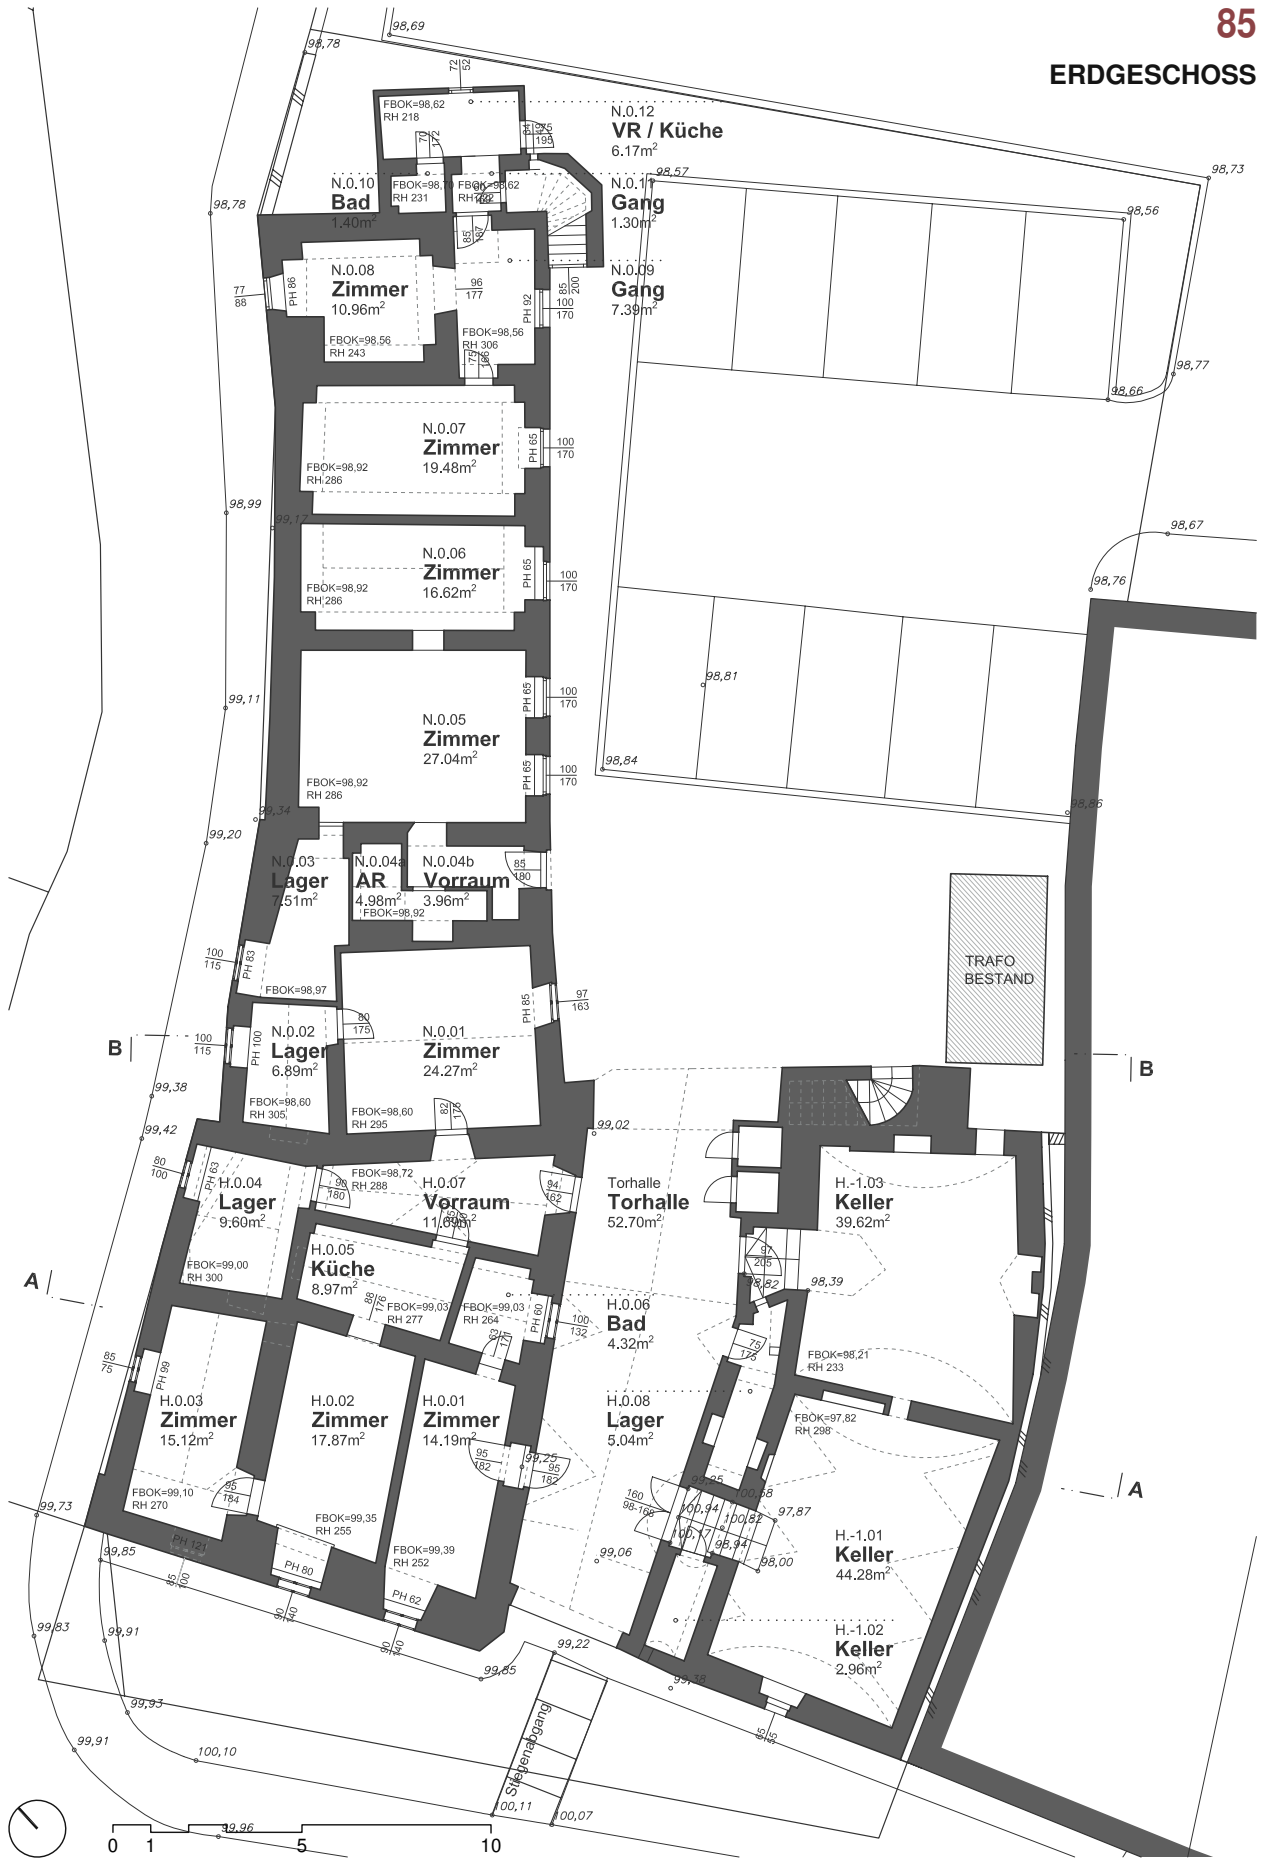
Bestandsplan Grundriss Erdgeschoß / Kellergeschoß
